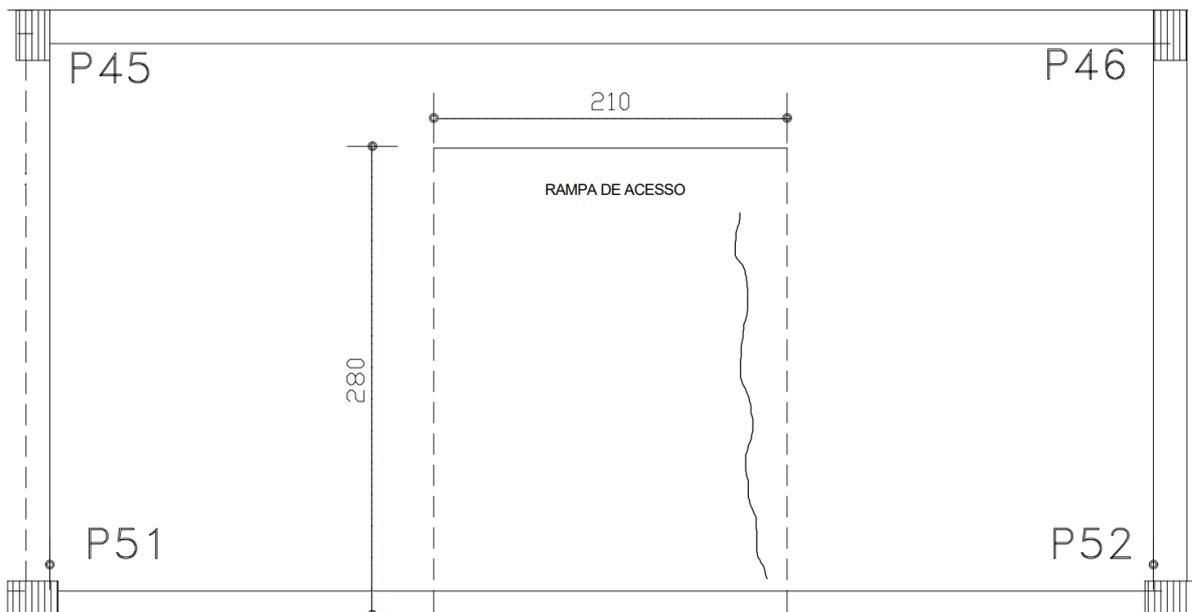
Croqui da laje onde foi identificada a fissura. (Fonte: autor).
